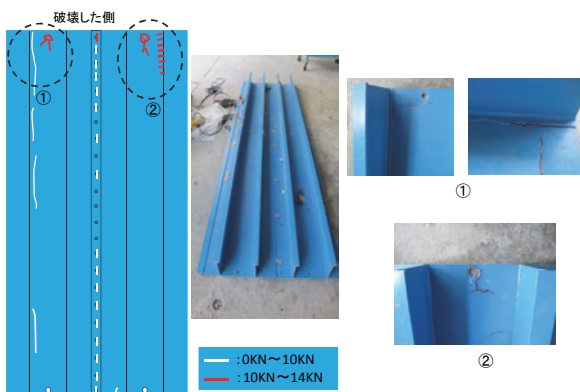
ひび割れ及び破壊状況図 (スタッドタイプ)
